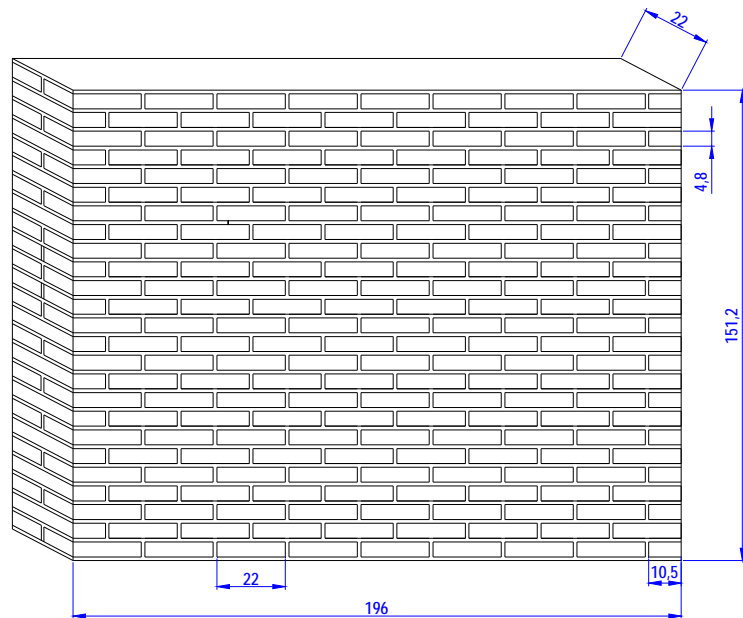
Geometría del muro de ladrillo construido en laboratorio (cotas en cm.)
